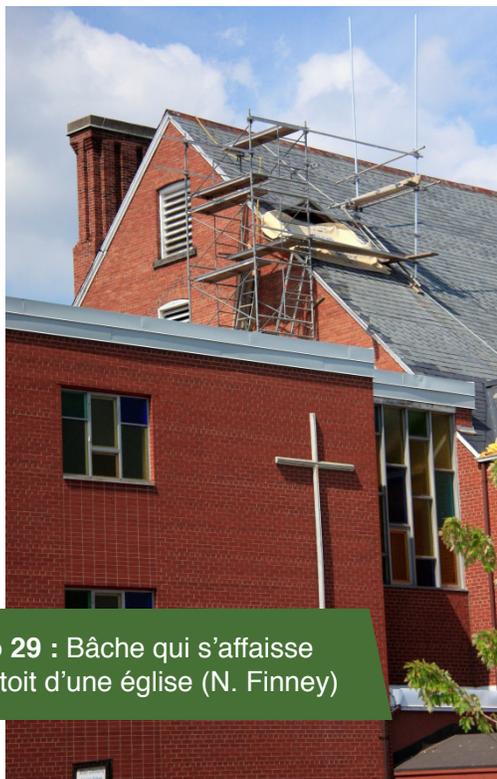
Bâche qui s'affaisse sur le toit d'une église (N. Finney)
